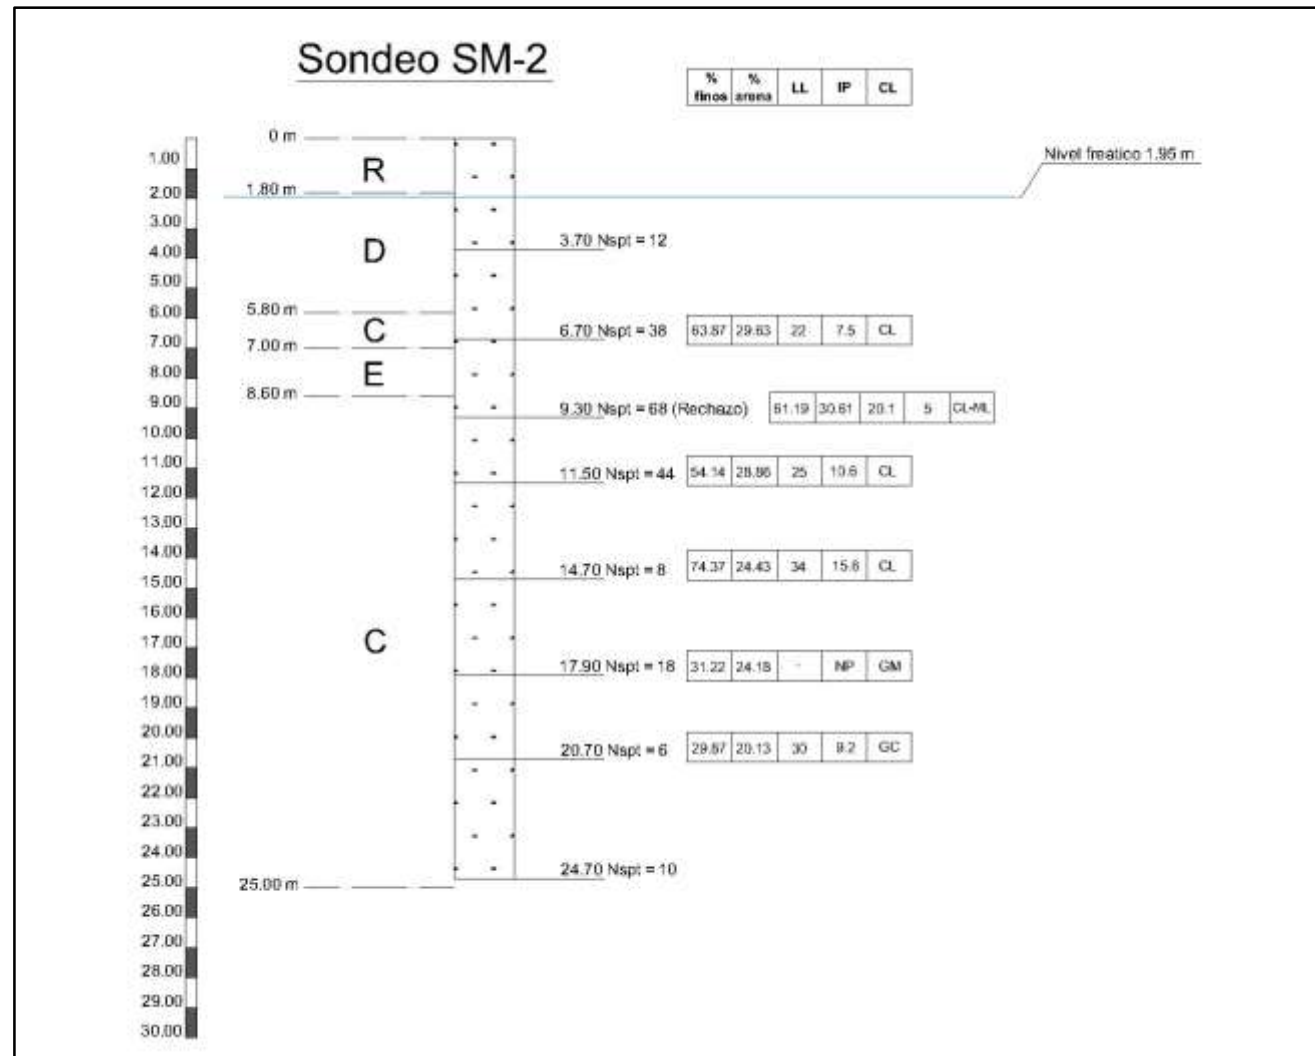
Características del terreno en el estribo norte. Fuente: Imagen realizada con AutoCAD.
